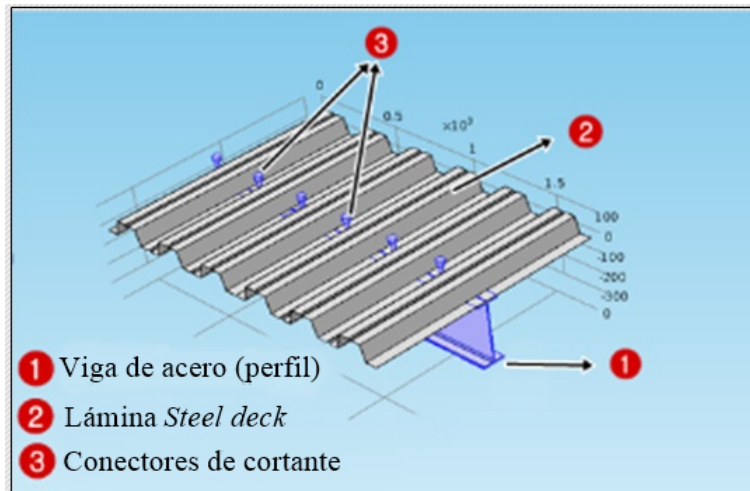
Sistema de losa en sección compuesta con nervios de la lámina perpendiculares al eje de la viga (antes de vaciar el concreto). Fuente: Autor
